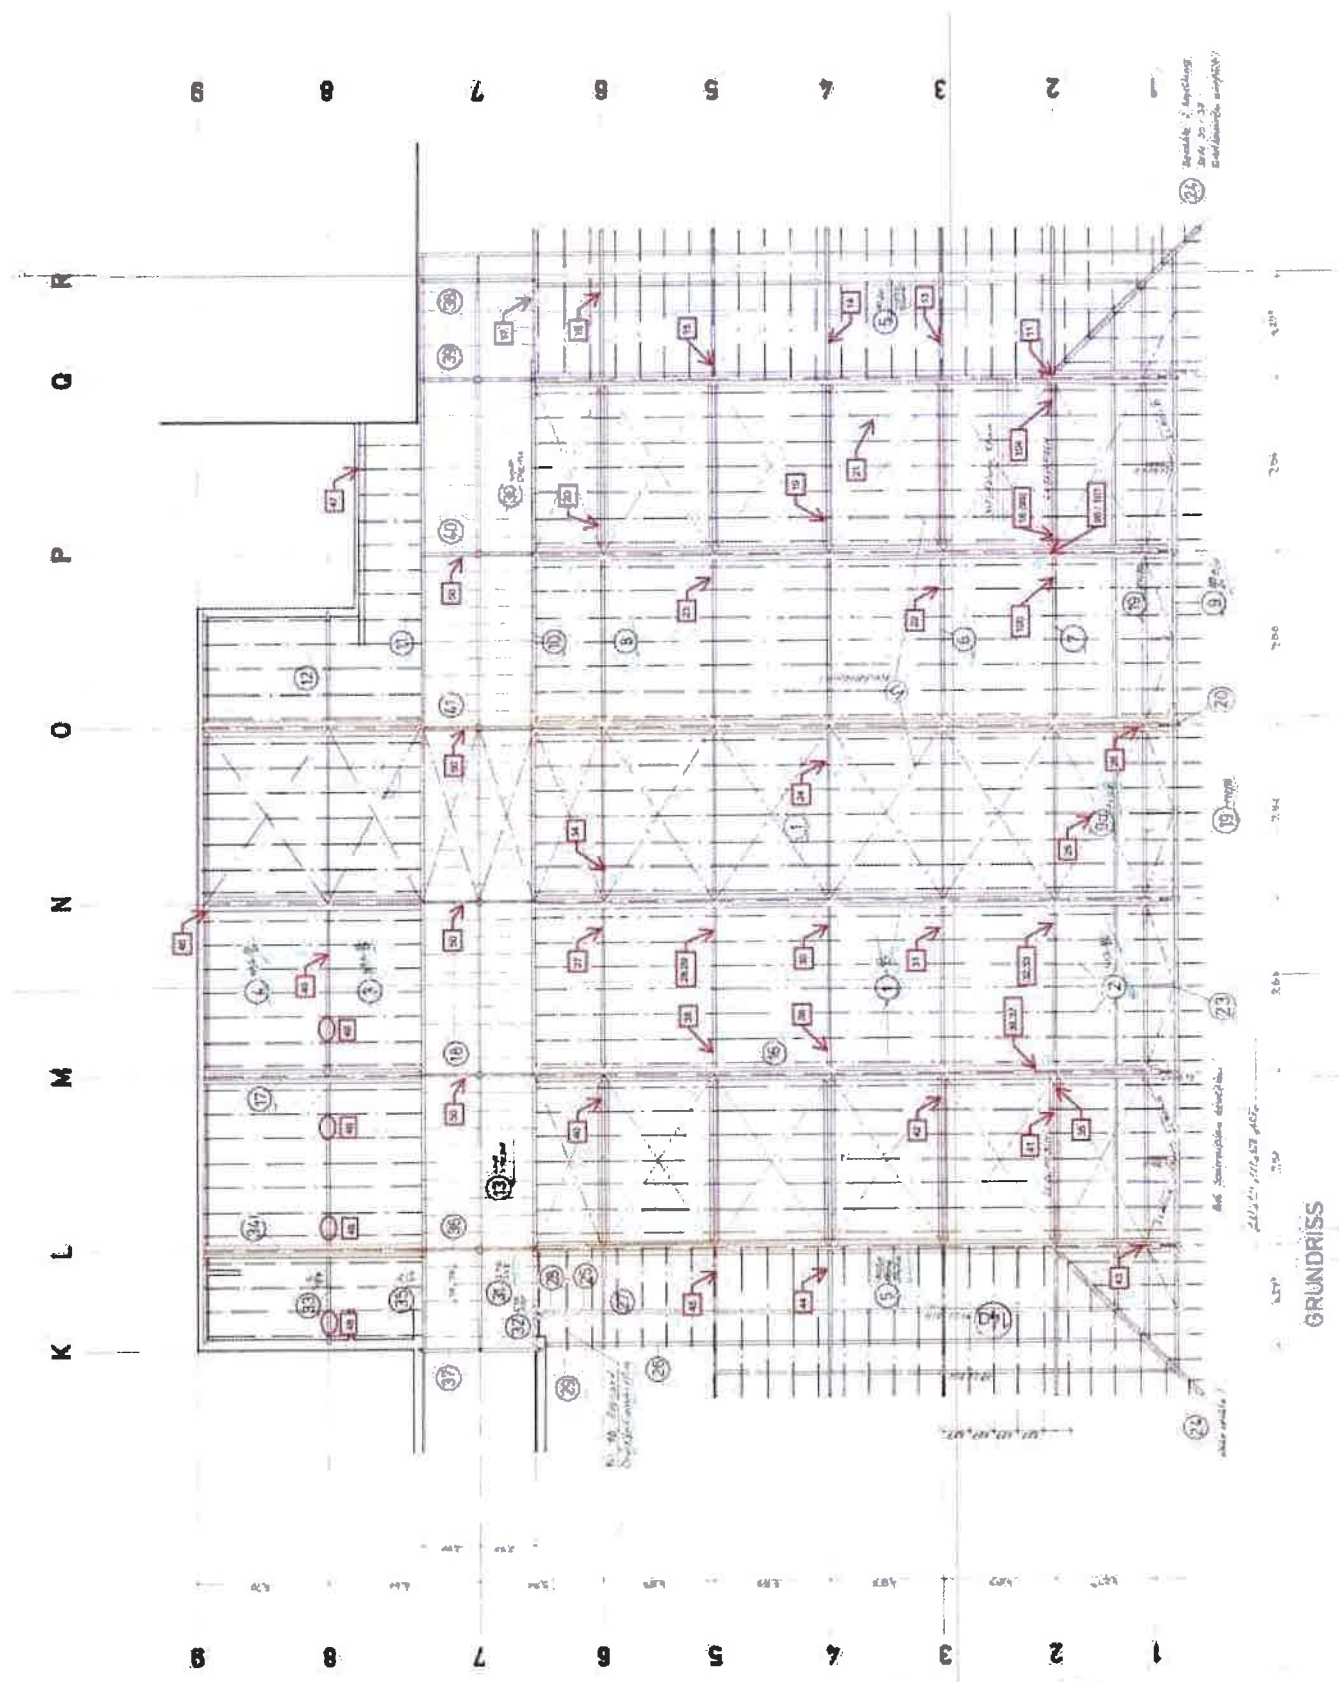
Ausschnitt Plan P1b / Übersicht der Dachöffnungen
